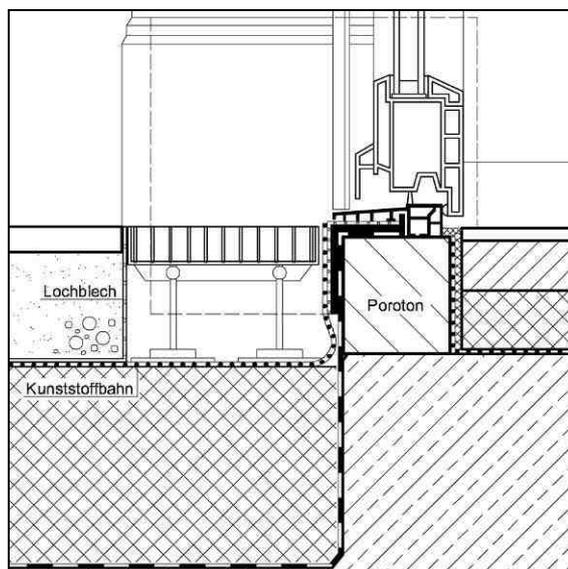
Detailskizze Türschwelle/Dachterrasse
